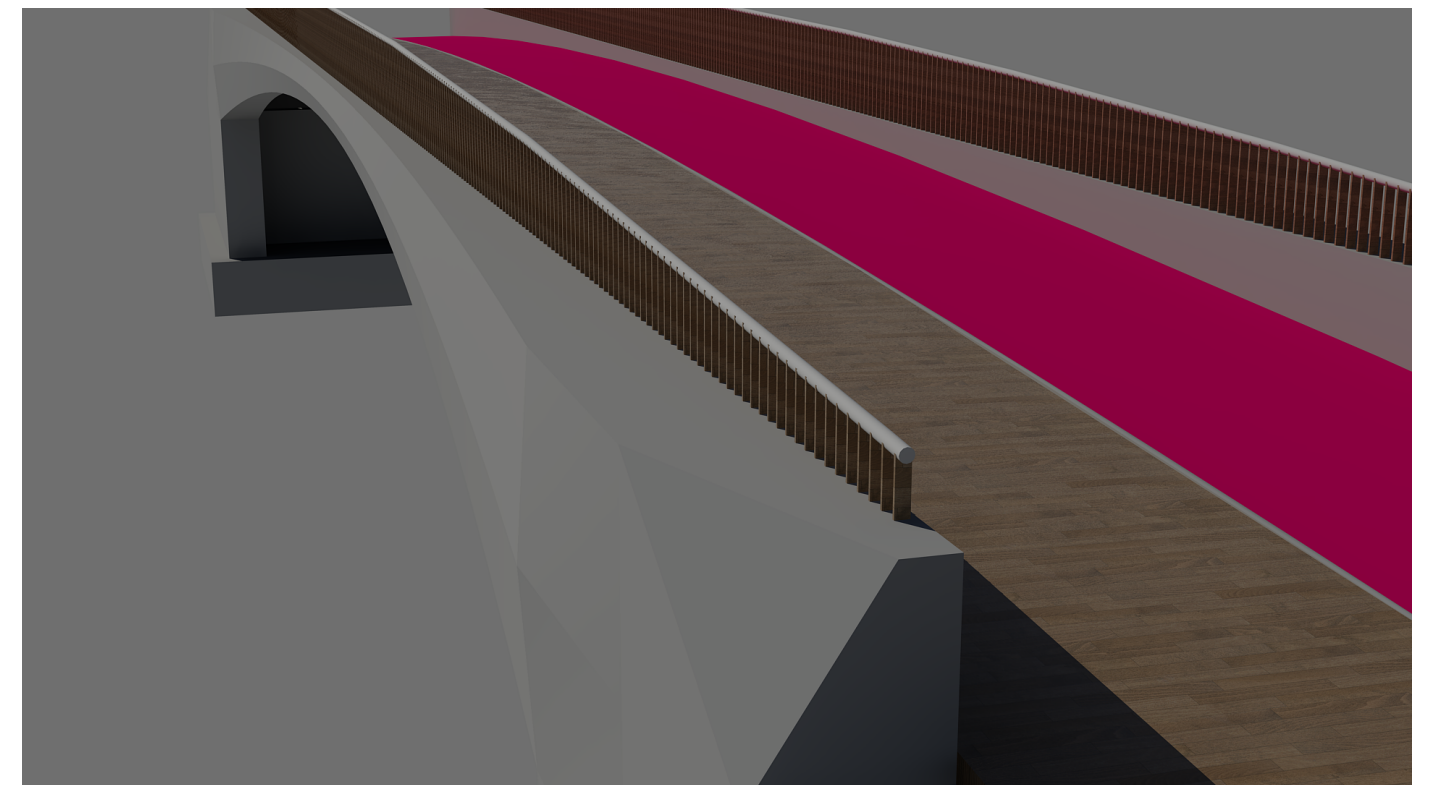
Vista tridimensional del conjunto pasarela-estribos.
